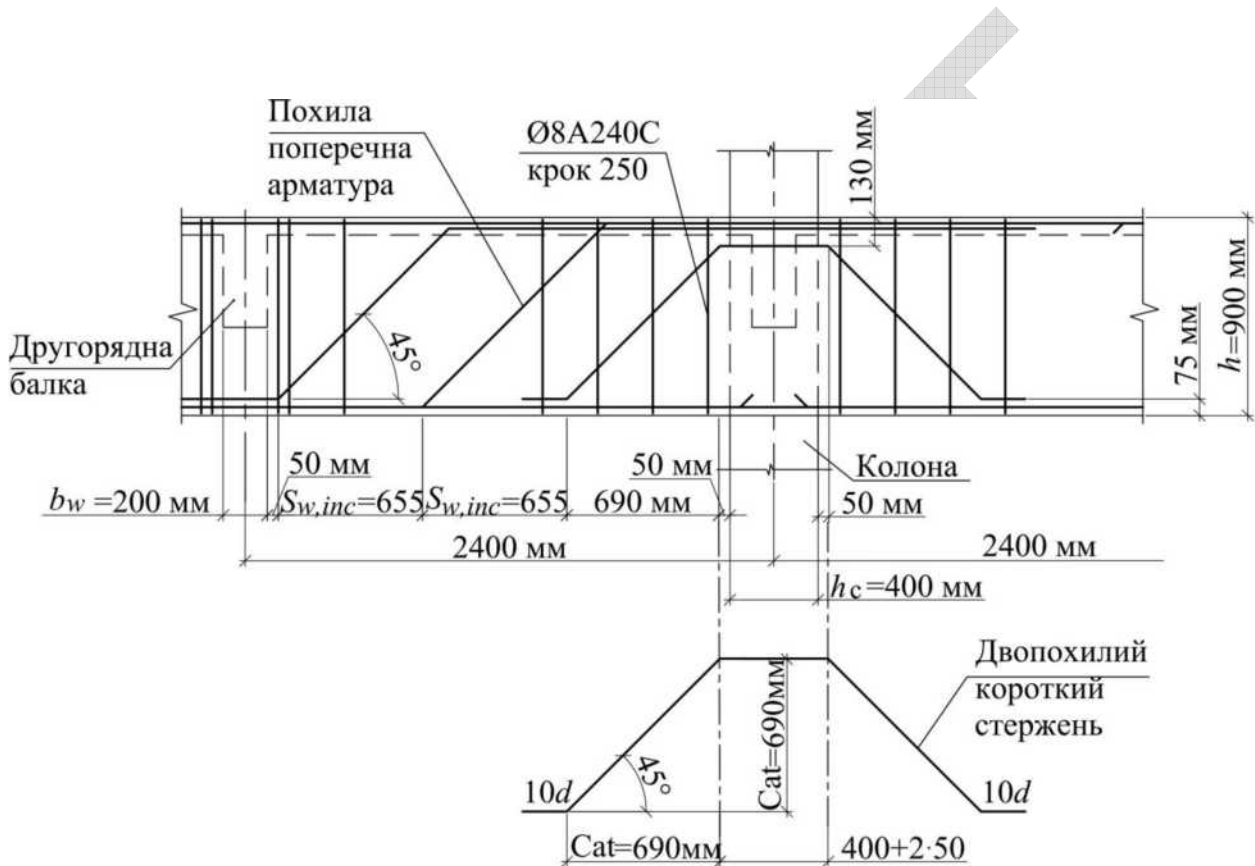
Схема армування балки похилою та вертикальною поперечною арматурою
